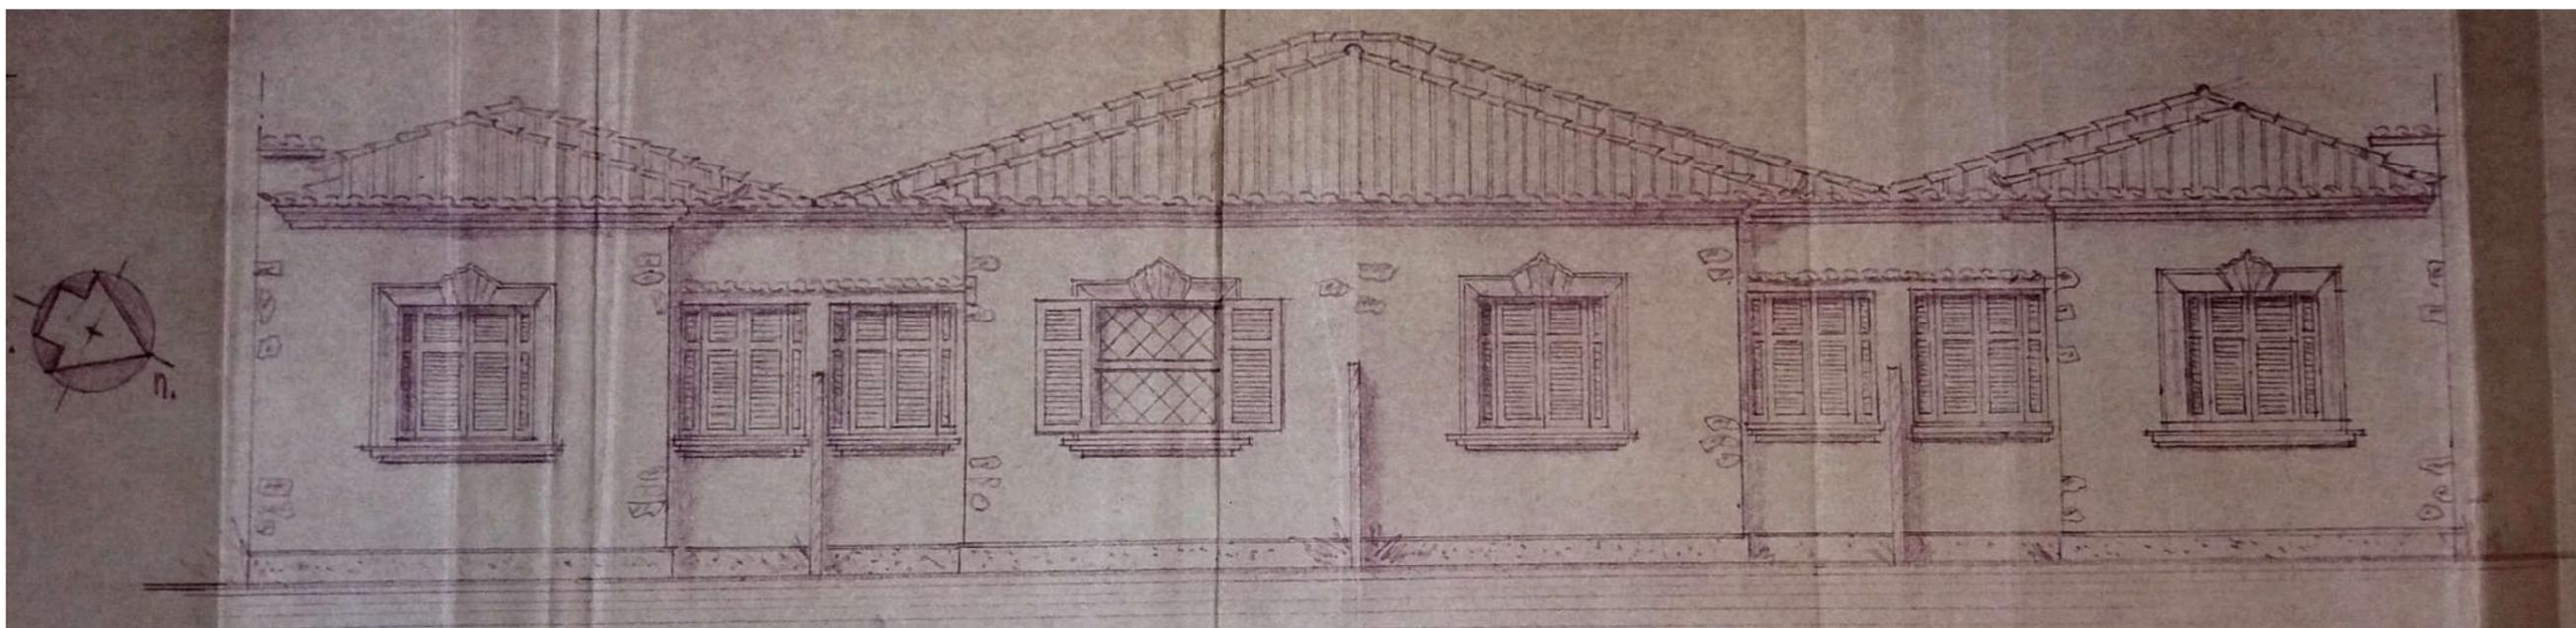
Foto do projeto, com o detalhe da fachada. Fonte: (GUARULHOS, 1949).
